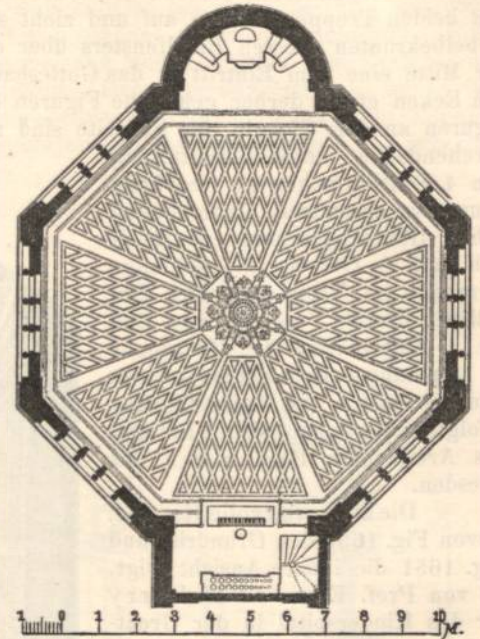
Grundriss in Höhe der Orgelempore.
